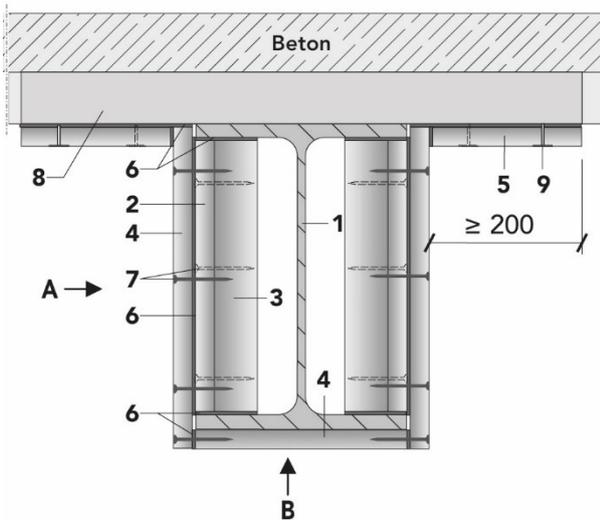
Anschluss an Stahltrapezblech-Verbunddecke – Variante 1 und Variante 2
